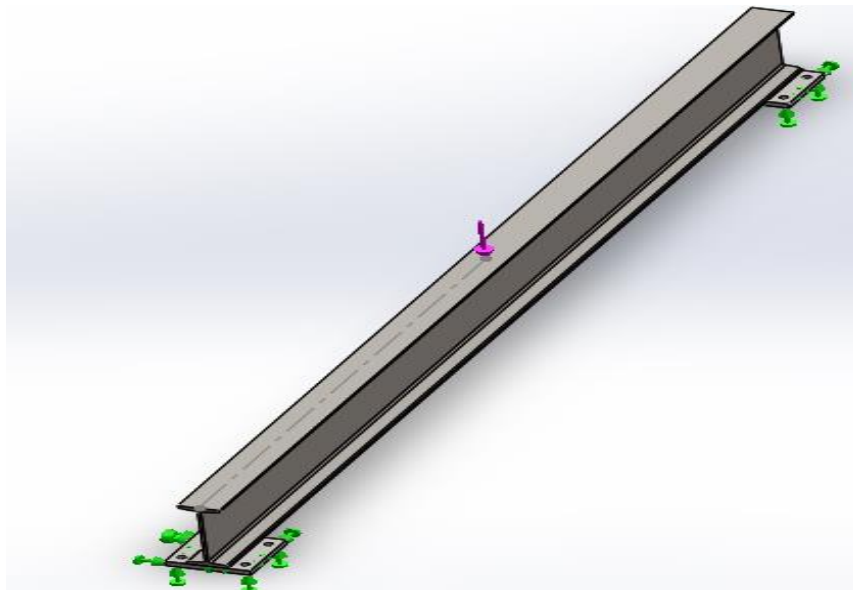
Carga en el centro y apoyos de la viga principal. Fuente: Autor
